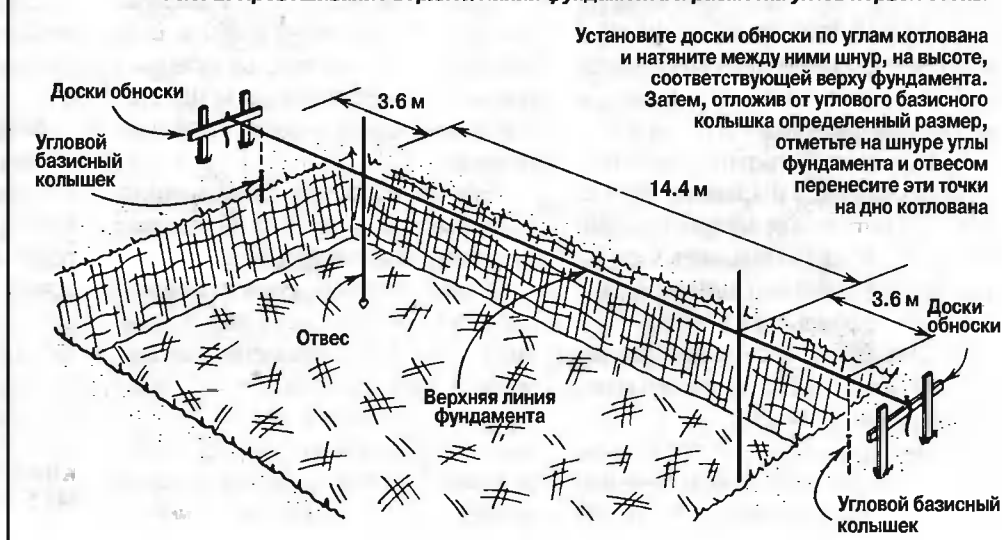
Провешивание верхней линии фундамента и разметка углов первой стены
